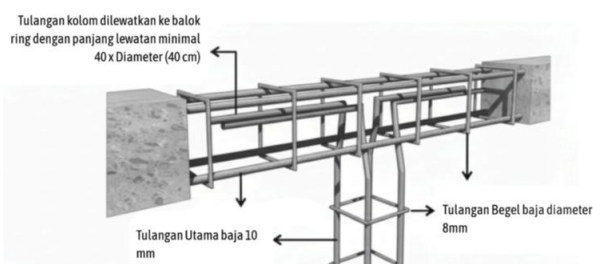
Detail Sambungan Kolom dan Balok Sloof
